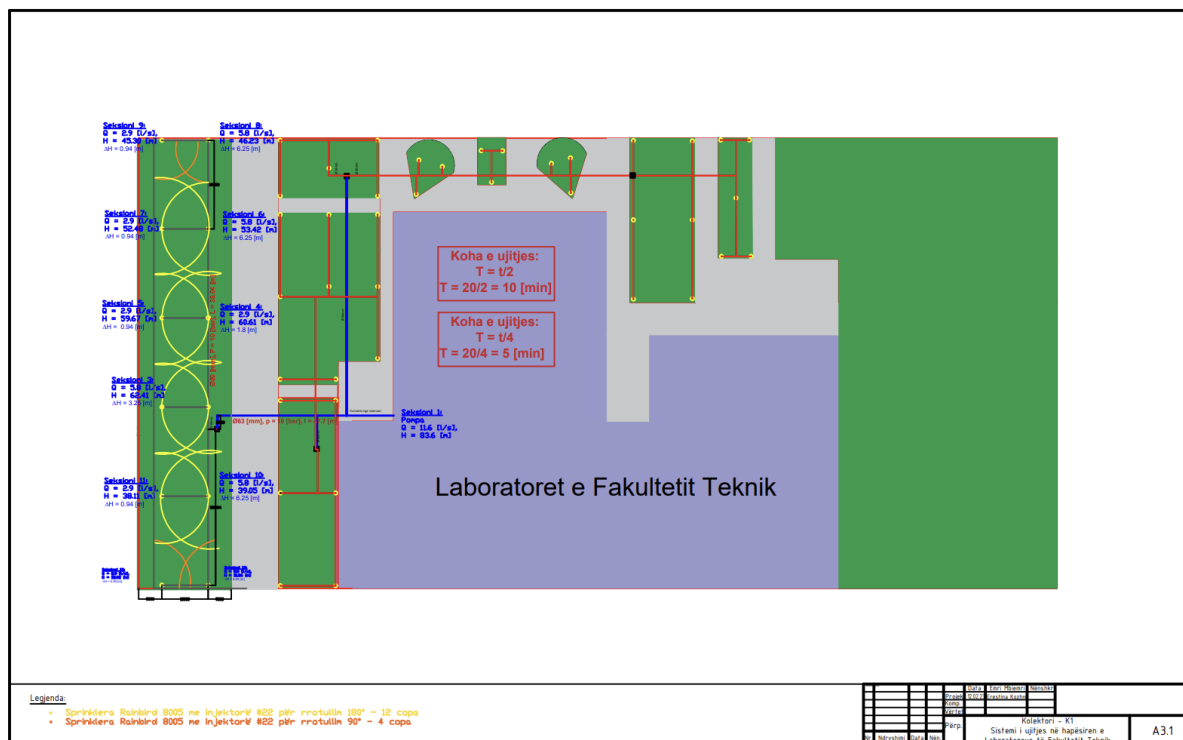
1 Plan Shtrirja e Zones I – Kolektori I
